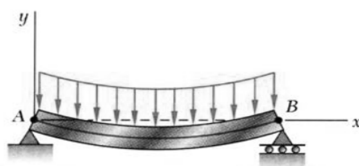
Carregamento uniforme em viga simplesmente apoiada [12]
